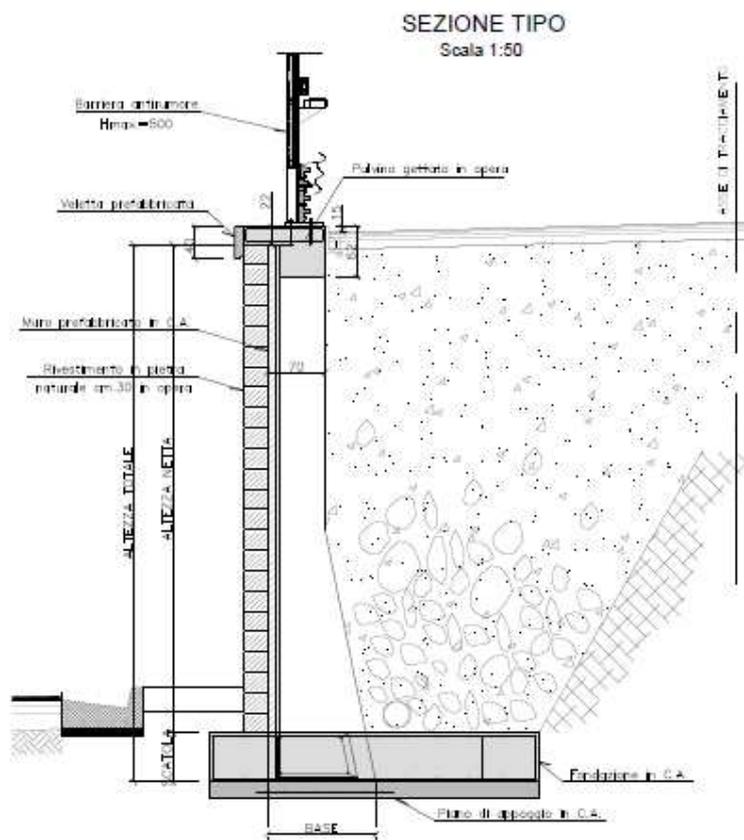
Sezione tipo muro di sostegno prefabbricato
